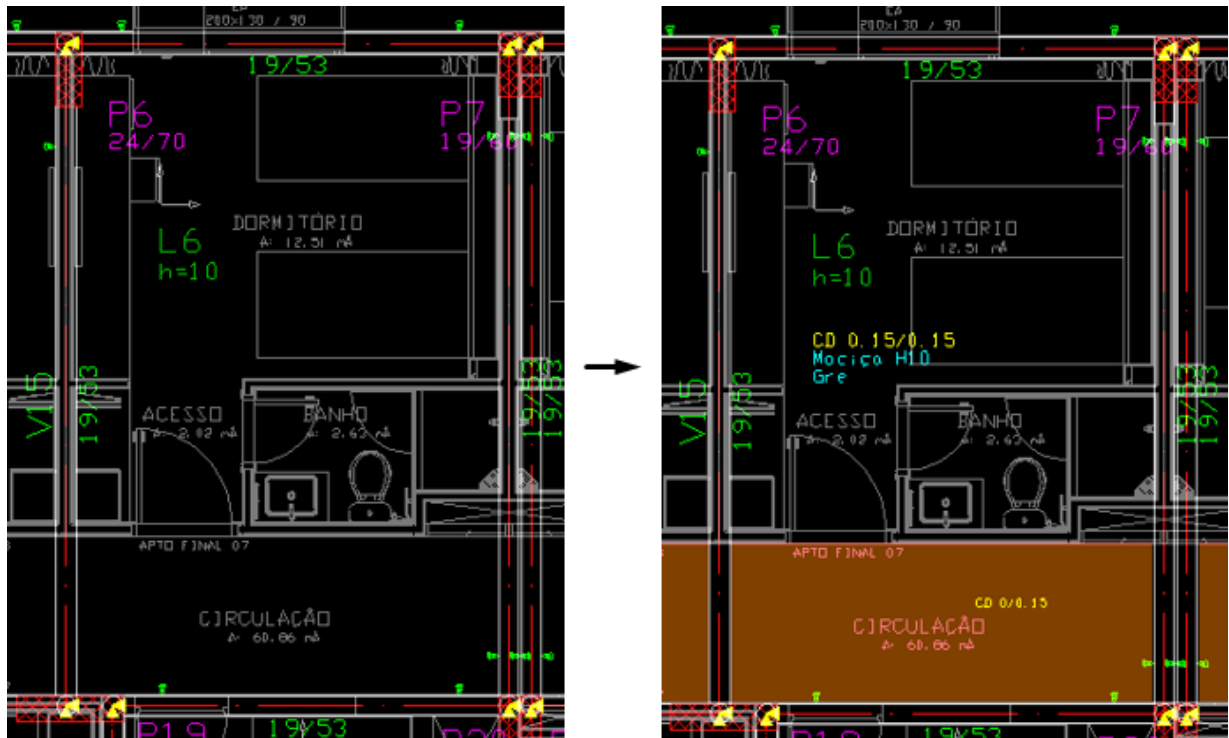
Laje L6, destaque para o carregamento distribuído lançado. (Fonte: Autor, 2023)
